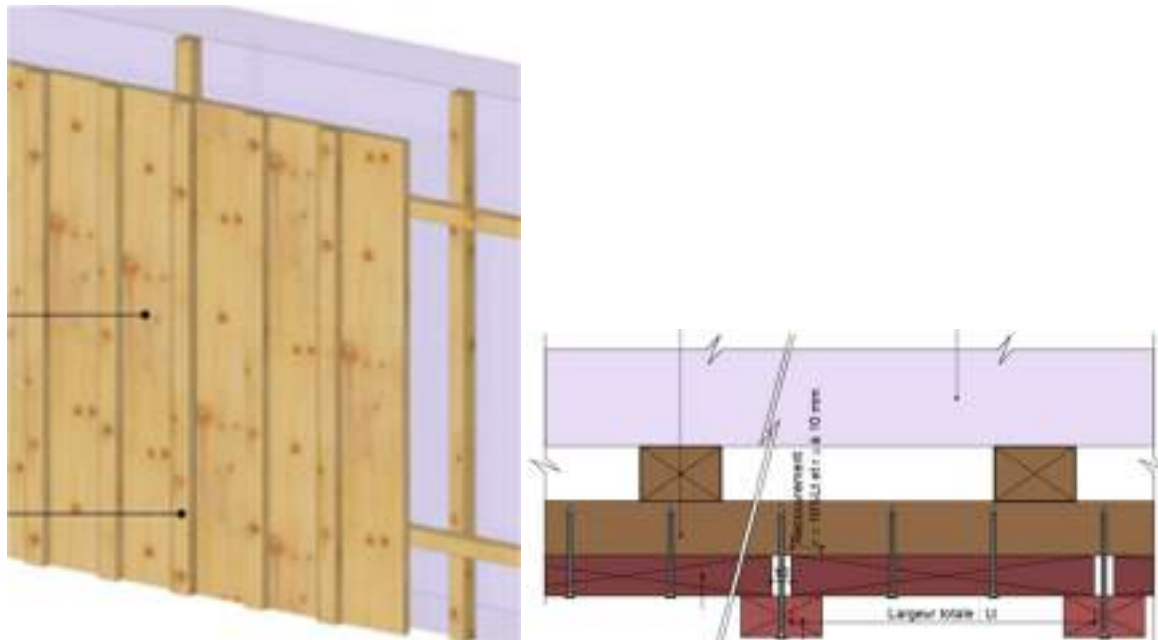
Lames à recouvrement – pose verticale (illustration 3D et coupe horizontale)
